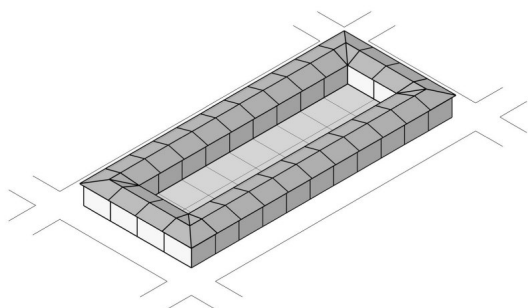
schema tipo della città a scacchiera con isolato chiuso
